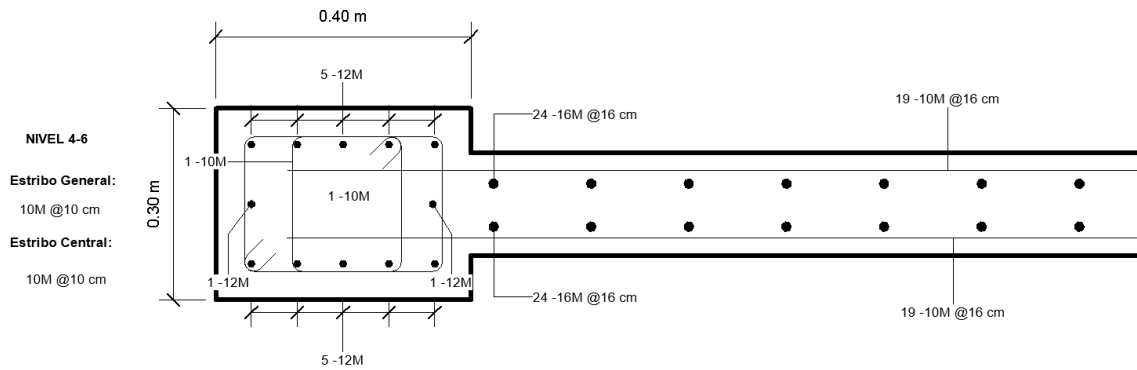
Secciones y armado de refuerzo cuando no se requiere elemento de borde para el sistema de 3 pisos
